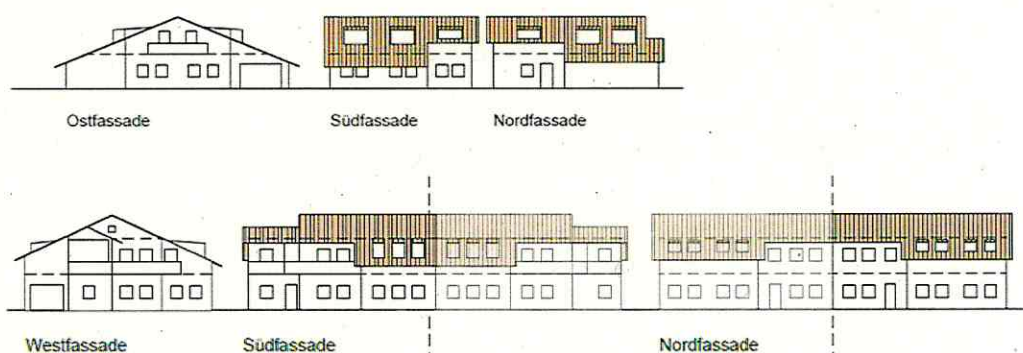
Untersuchung Höhenentwicklung, oben Einzelhaus, unten Doppelhaus, PV München, Stand Mai 2025
